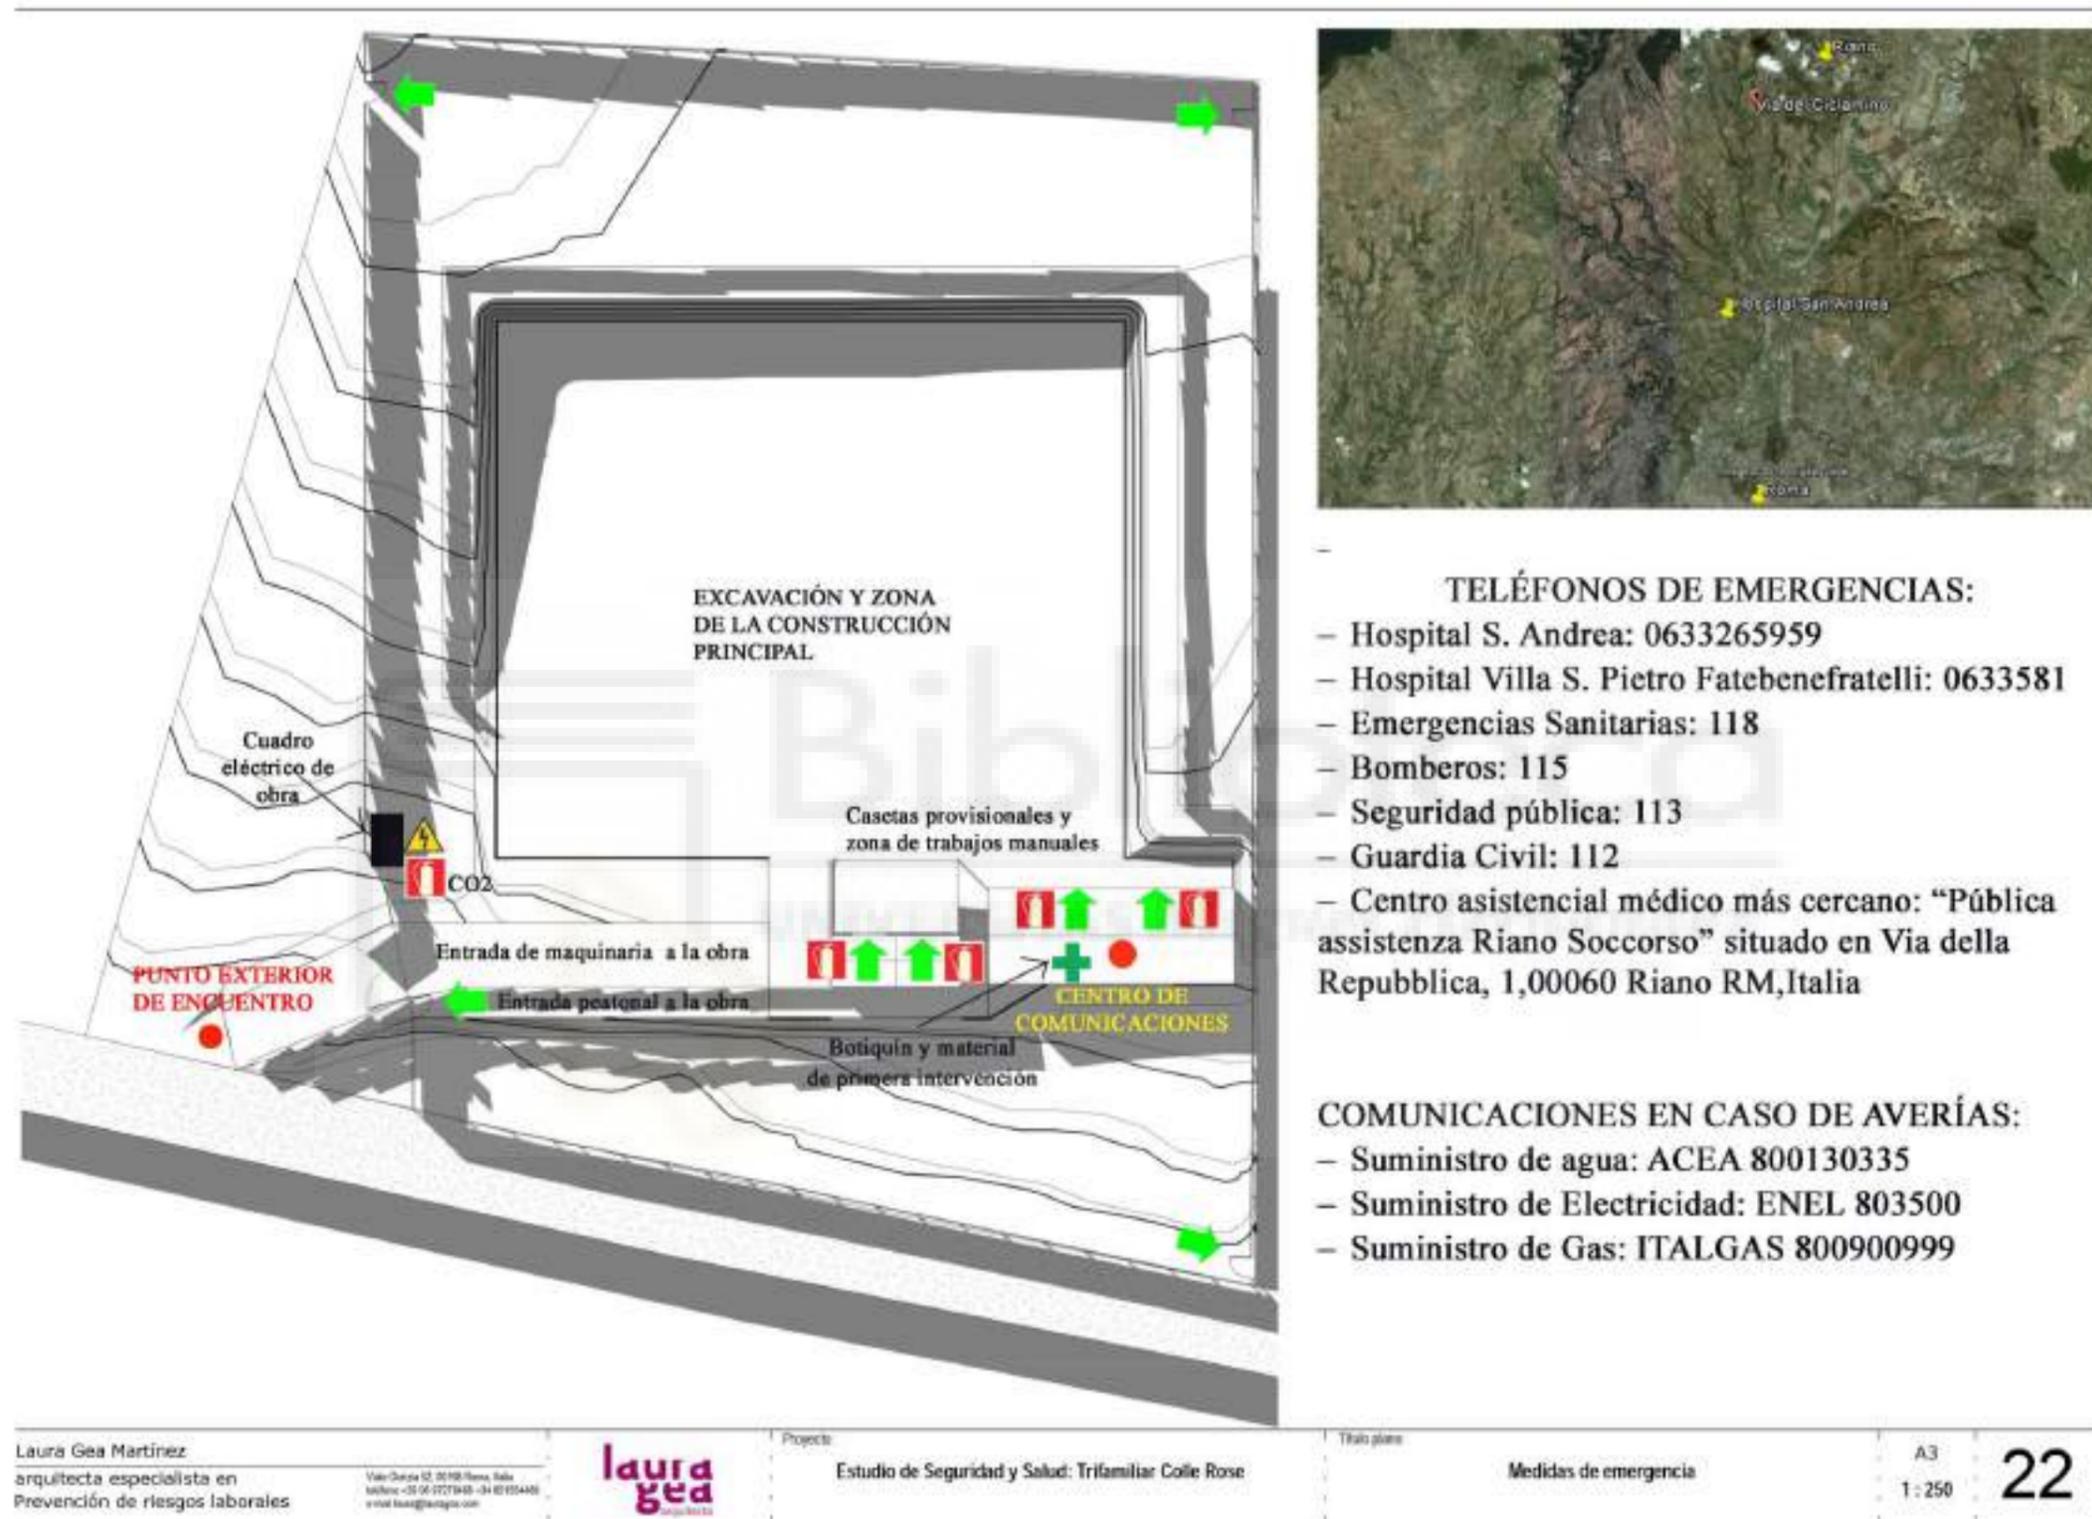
Plano 22, medidas de emergencia. Fuente: elaboración propia a partir de la planta de obra realizada con modelo BIM
